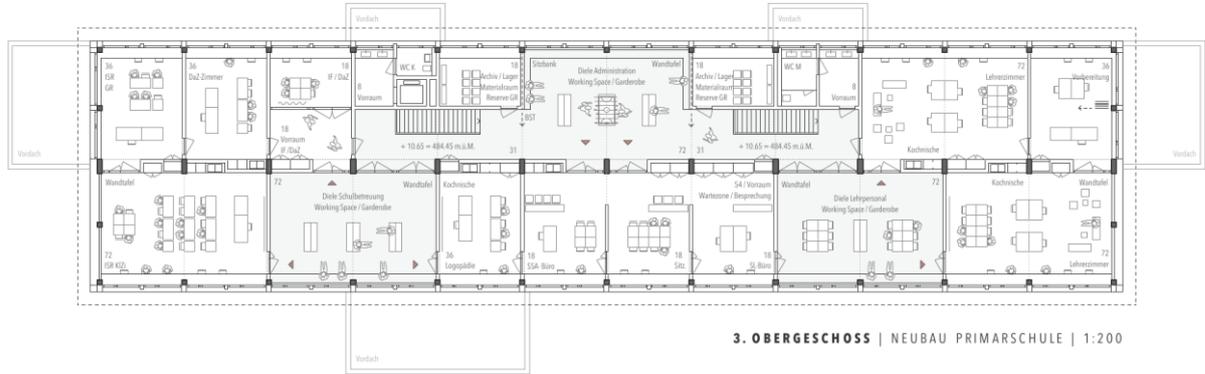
Neubau Primarschule, Grundriss 3. Obergeschoss
